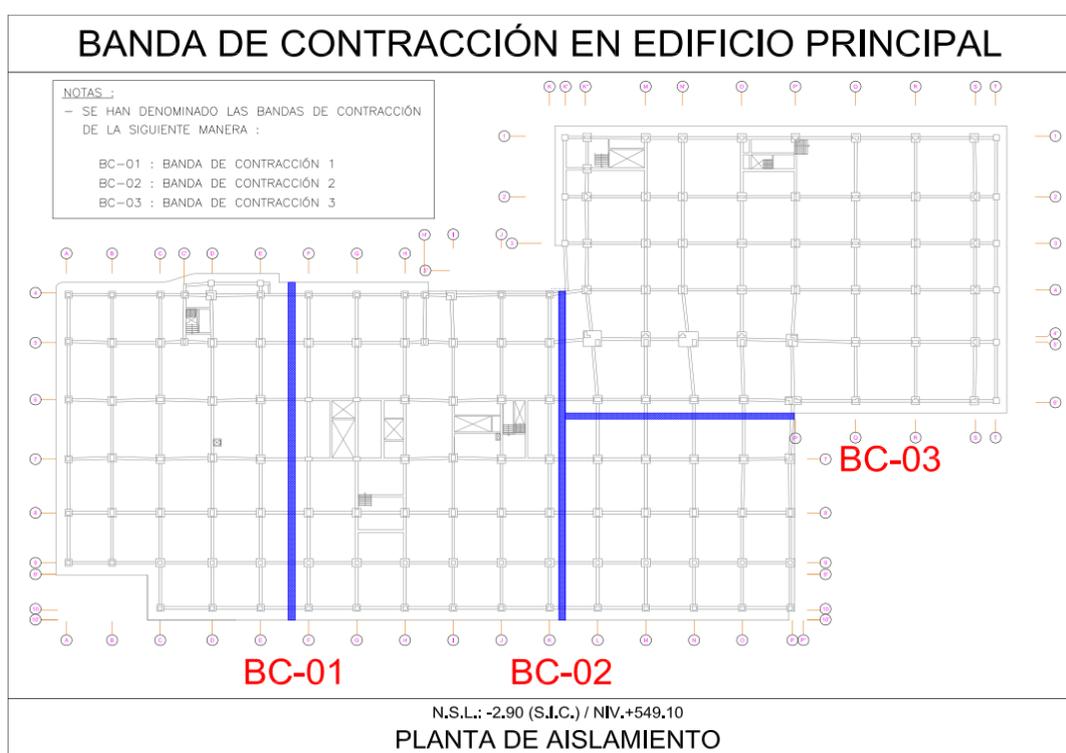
Bandas de Contracción en la Planta de Aislamiento (Fuente: Consorcio Salud Tacna)
